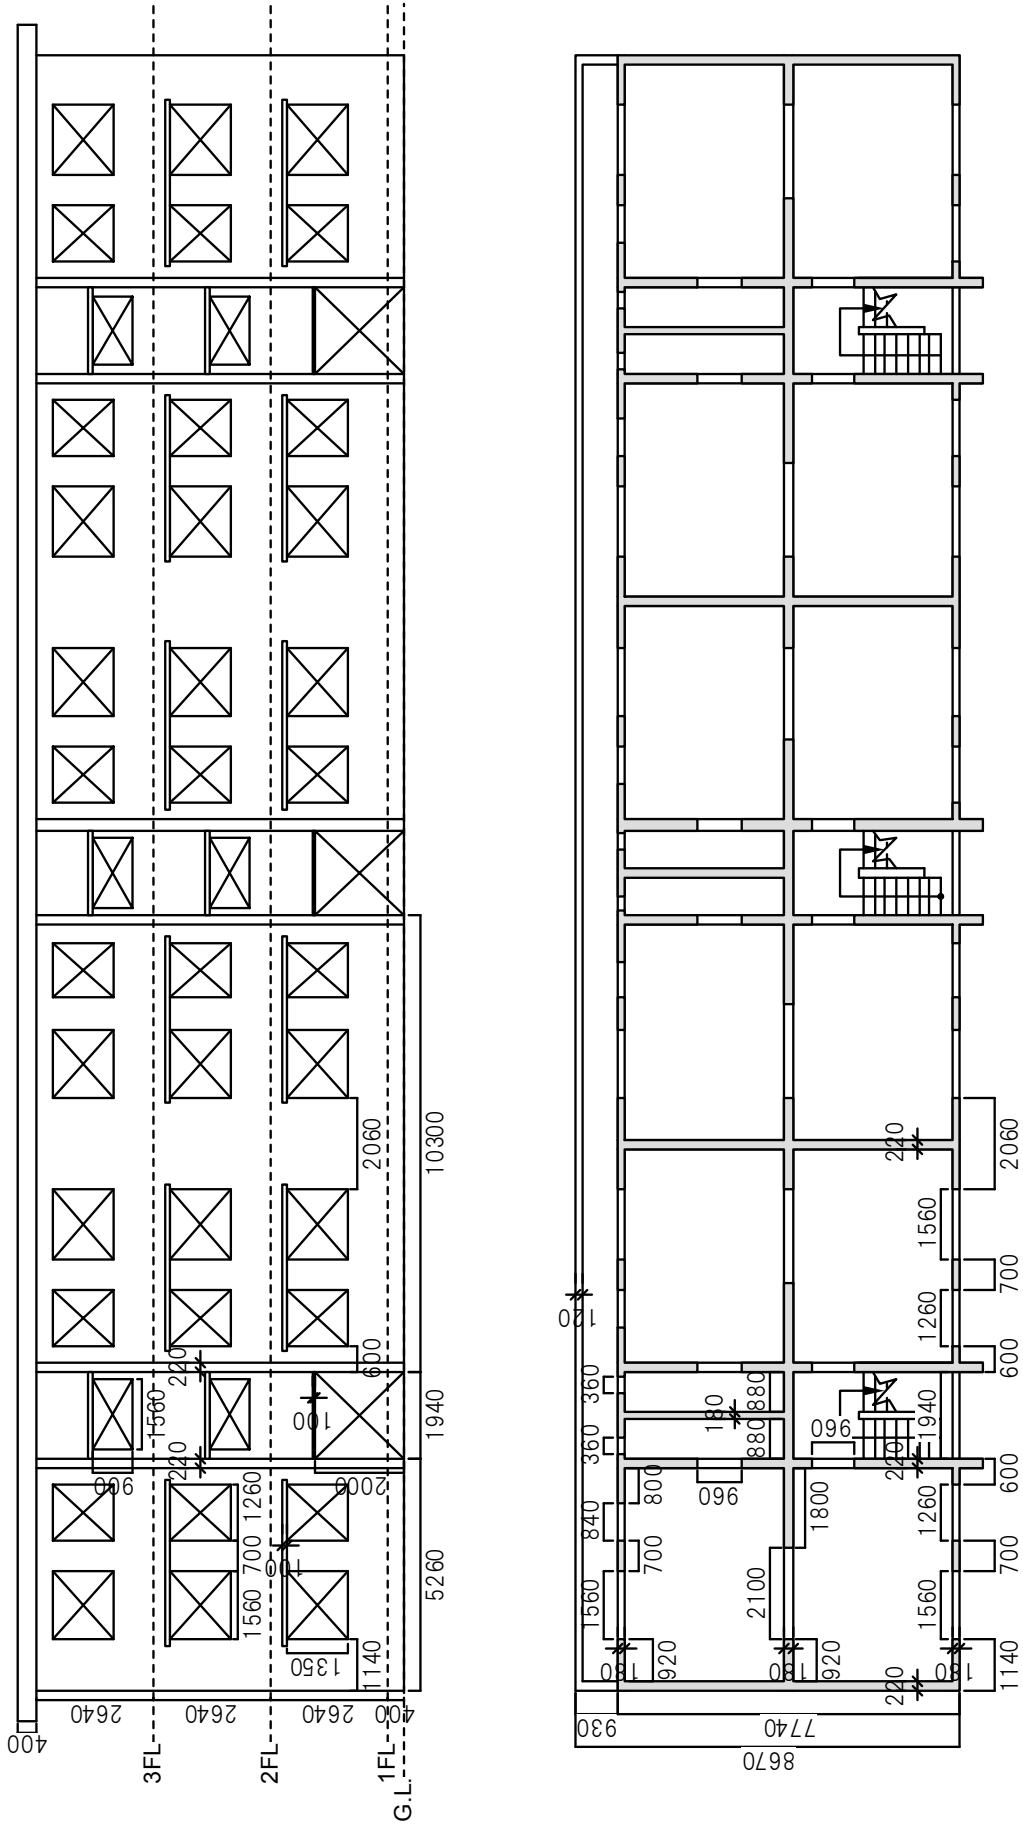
片岸市営住宅 北立面図・平面図 (単位 : mm)
